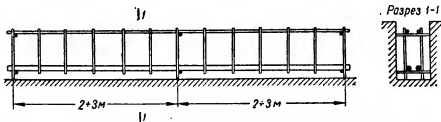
Арматурный каркас балки с упорами в виде удлиненных поперечных стержней.
